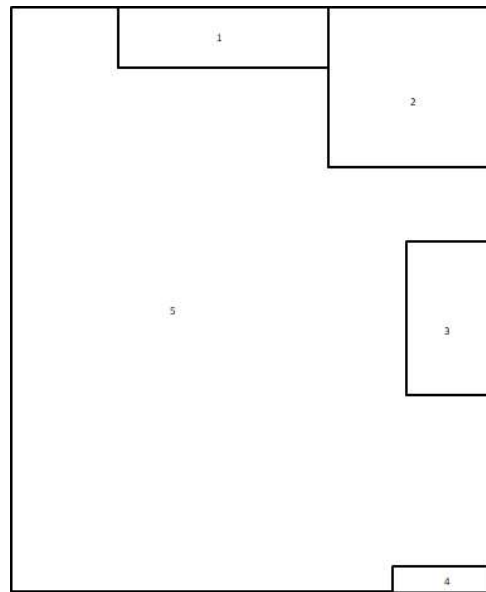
17 Plan 1st floor Latar Ijen Resto & Coffeeshop
